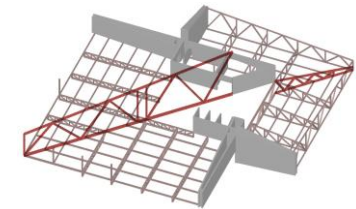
Ubicación viga en celosía 4 en estructura de P3.
